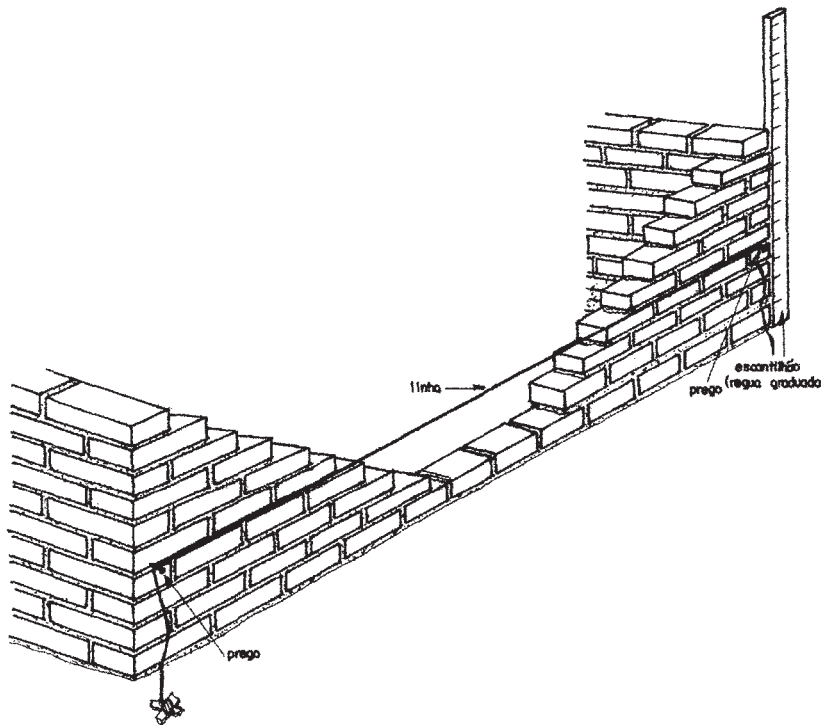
Detalhe do nivelamento da elevação da alvenaria.
